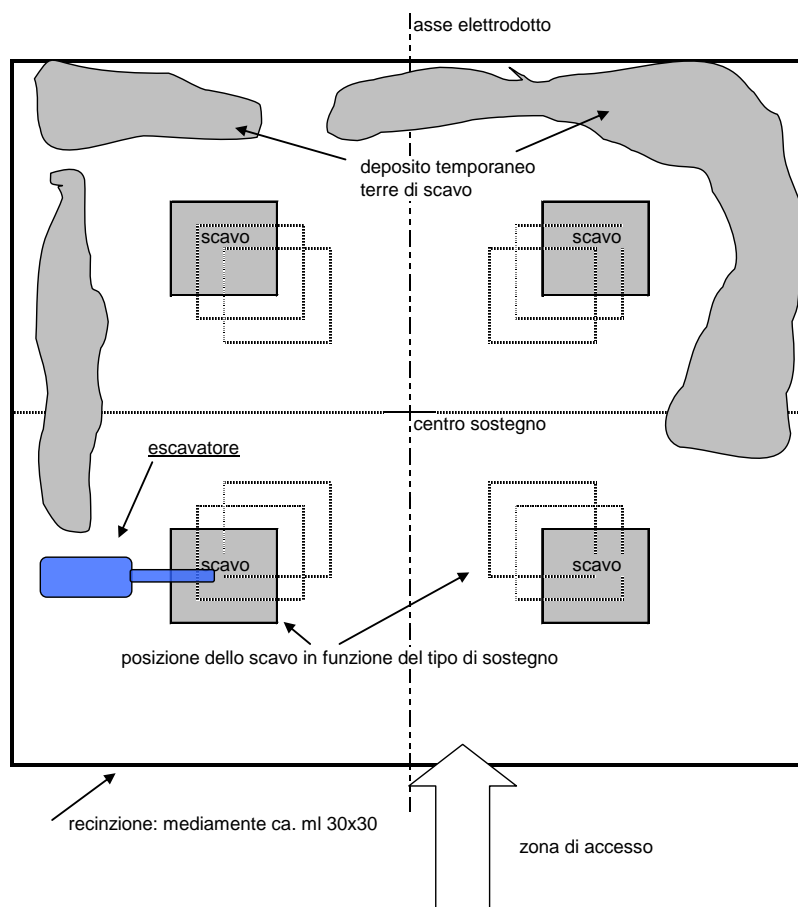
Planimetria dell'area di sostegno (scavo di fondazione)
